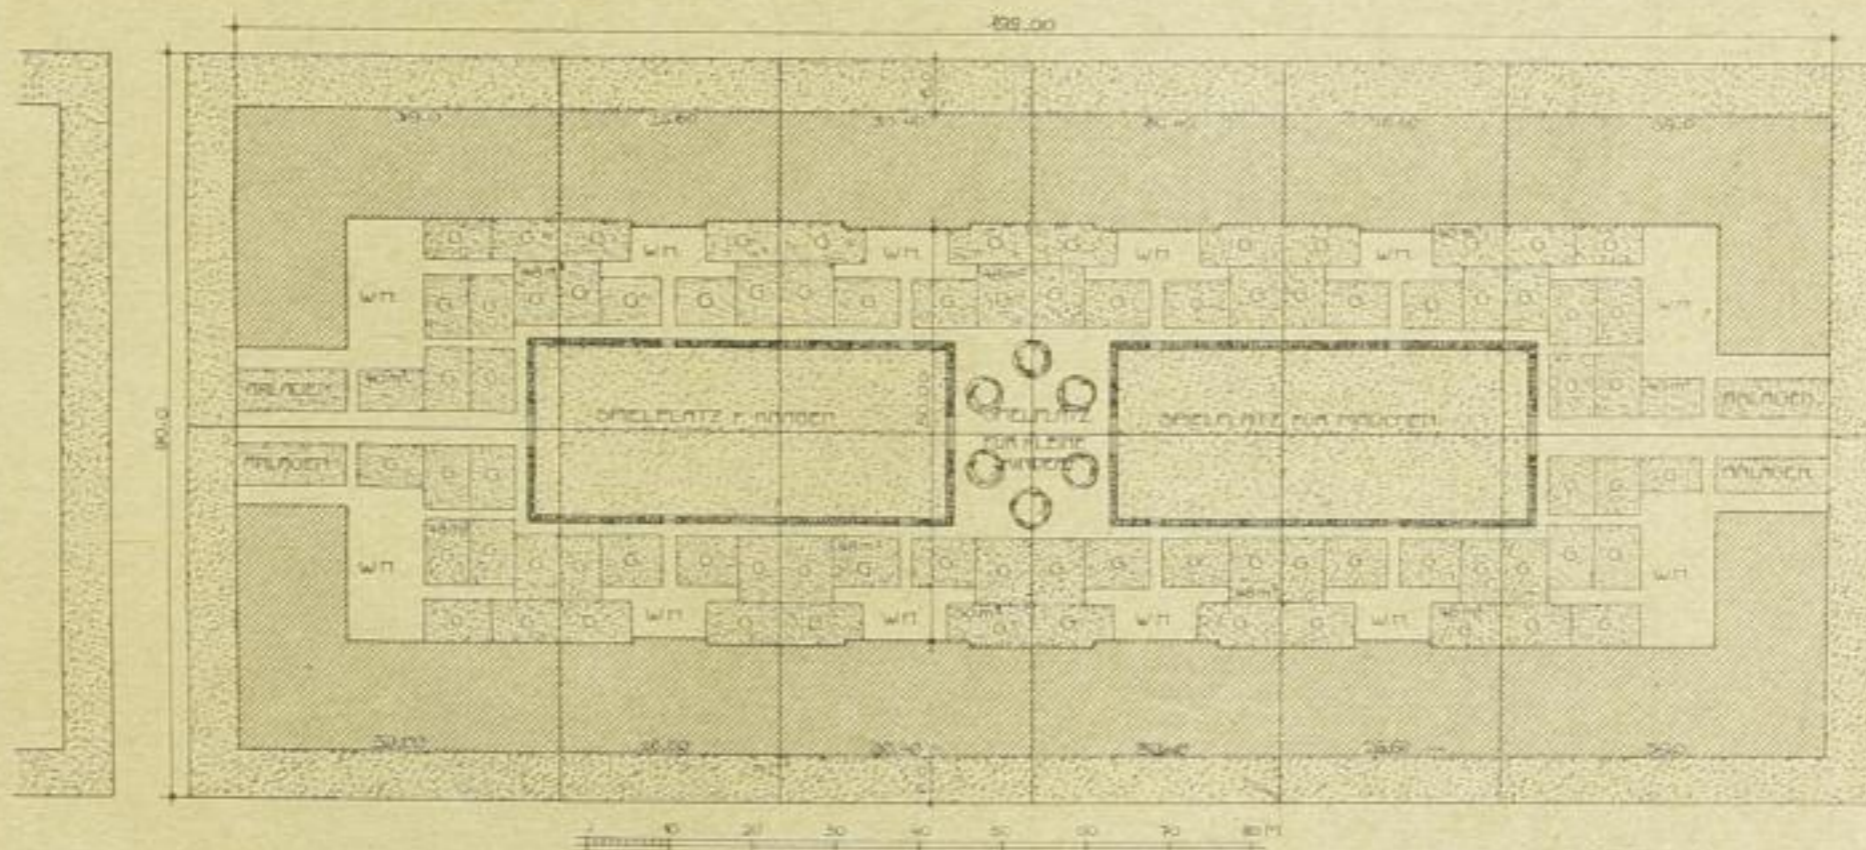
Typ eines Baublocks mit 3 geschossiger Mietshausbebauung. Maßstab 1:1500.
